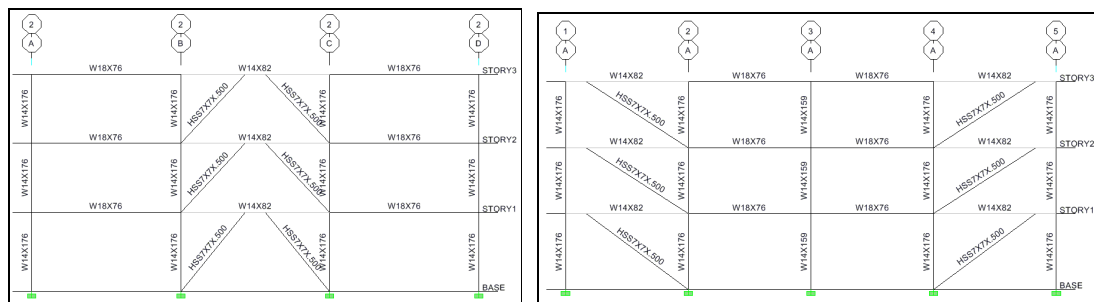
Secciones edificio de 3 niveles. Elevación.
